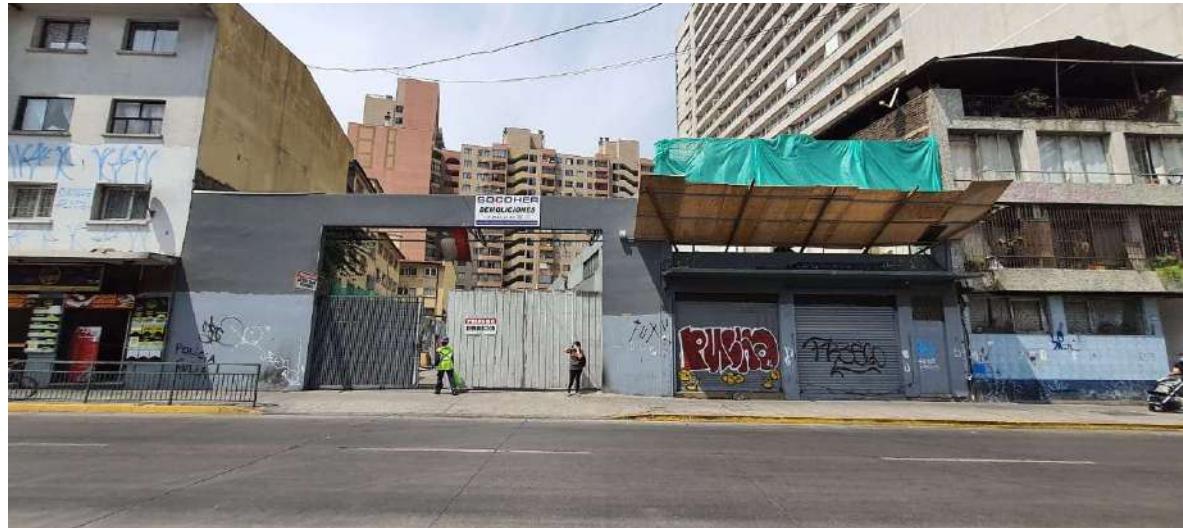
Rebaje fachada 2do piso con abanico de protección
